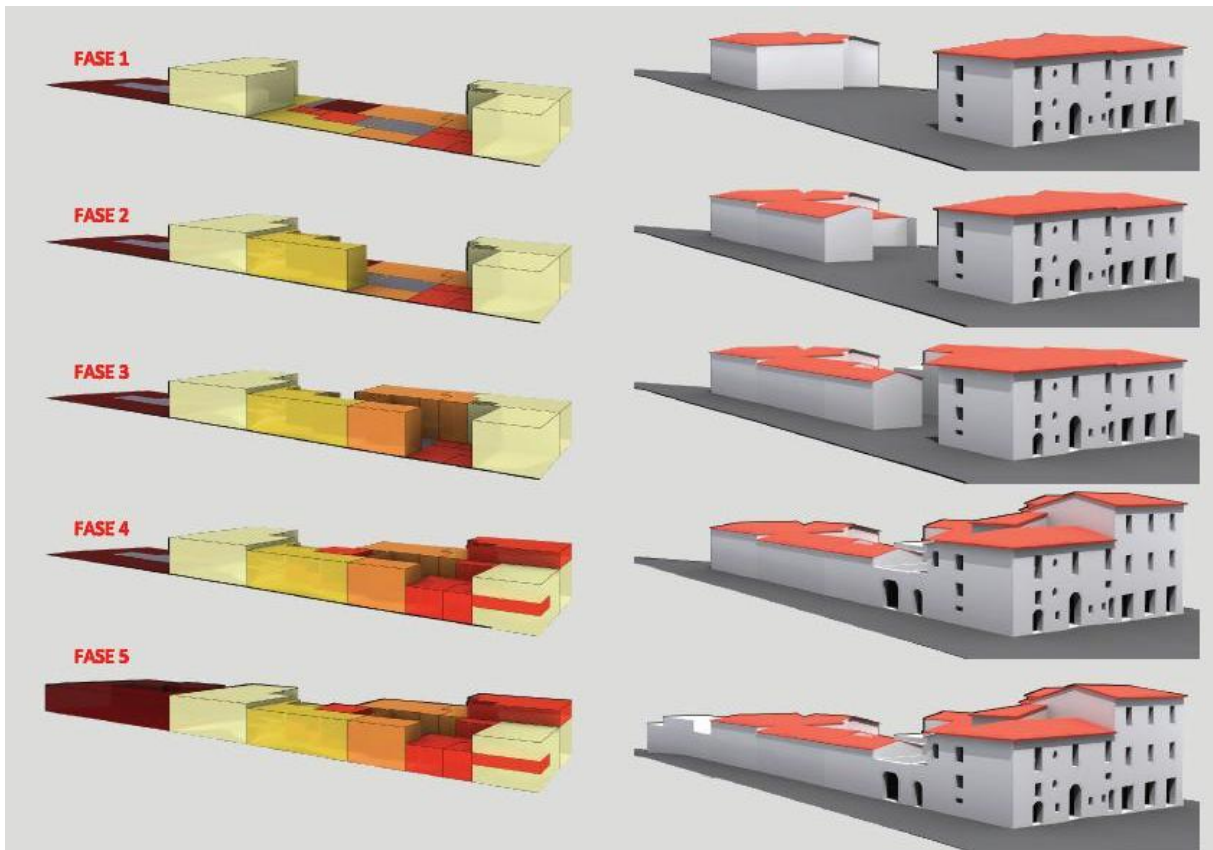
Individuazione delle sopraelevazioni e delle unità ad un piano.
